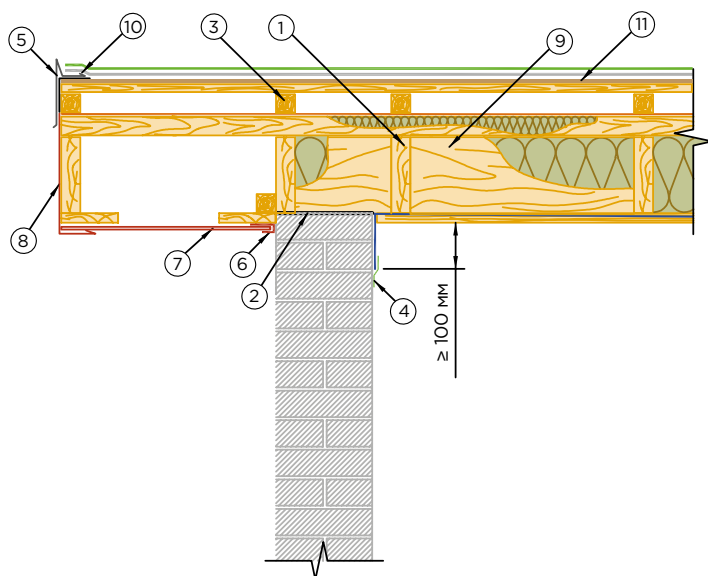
Конструкция перекрытия «холодного» чердака
